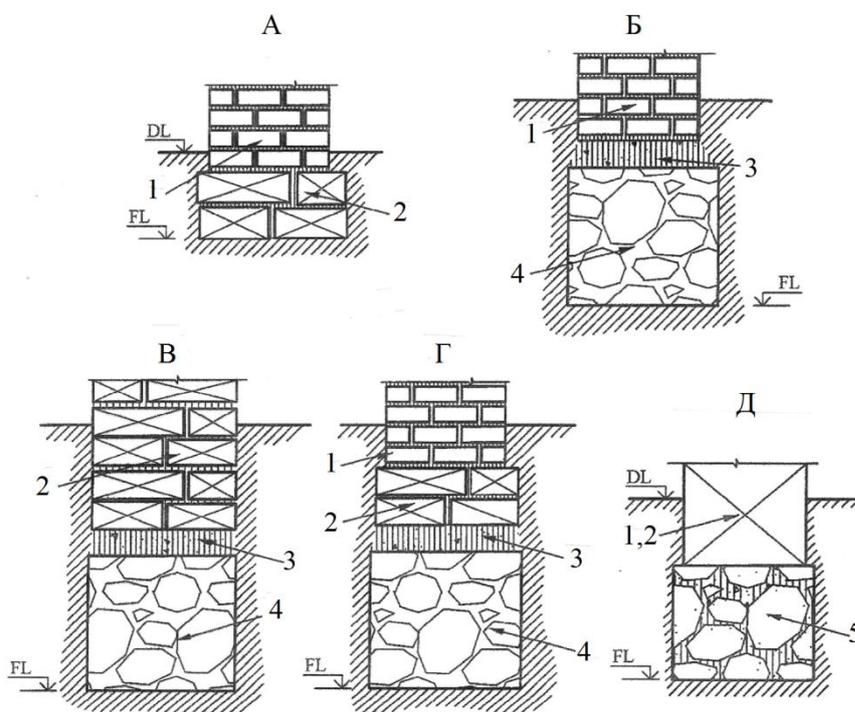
Конструктивные схемы бутовых фундаментов с прямоугольным поперечным сечением
